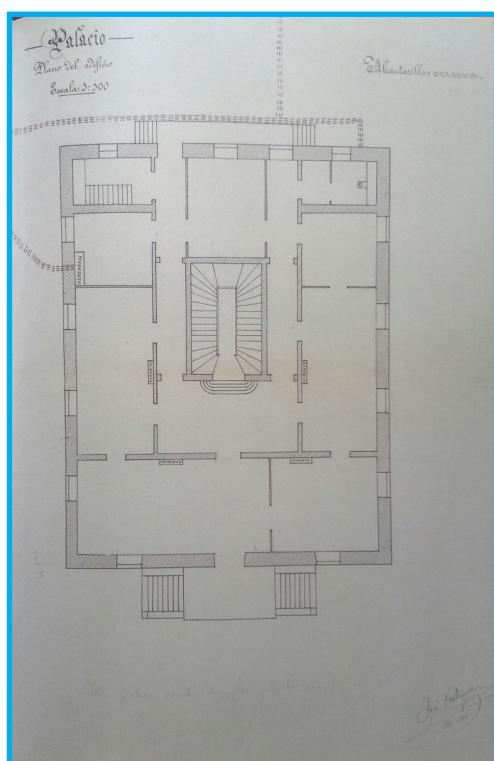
Plano planta del edificio el Palacio, en Alhama de Aragón. Col. privada.
